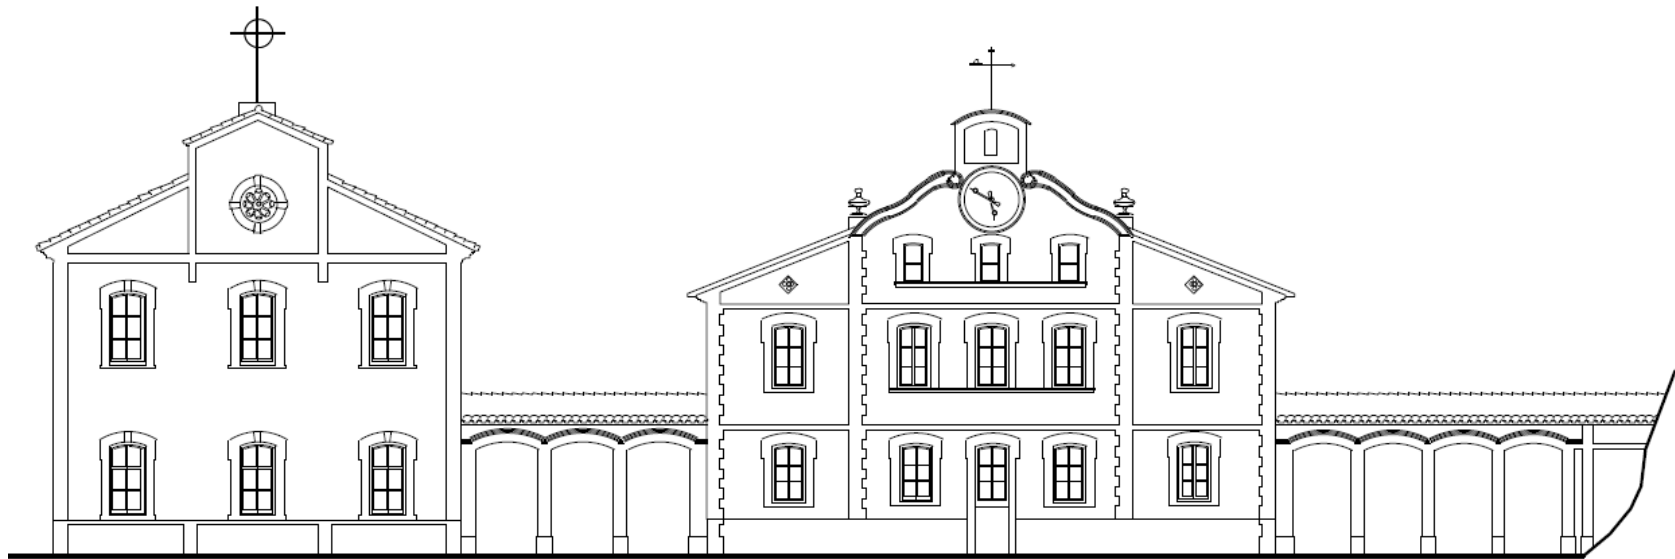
Levantamiento planimétrico de las fachadas del Pabellón Central y Pabellón de La Purísima. Periodo 915-1943. Orientación Sur.
